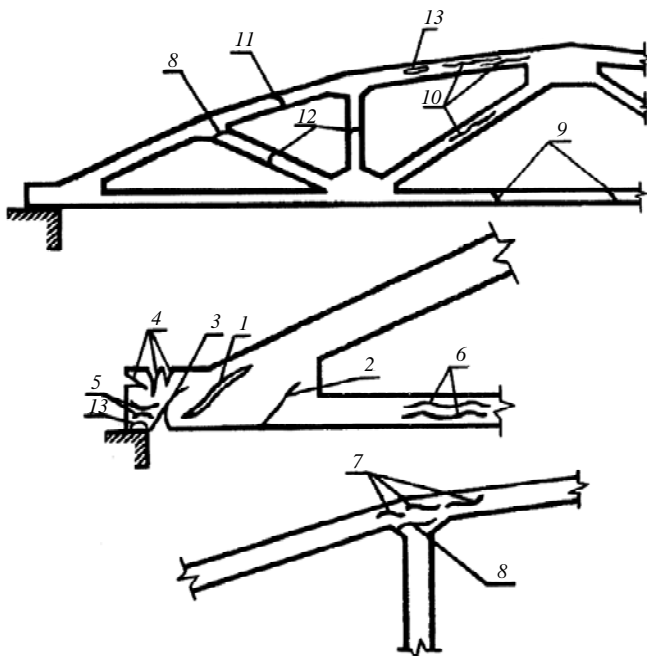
Картина трещинообразования в стропильной раскосной ферме.
